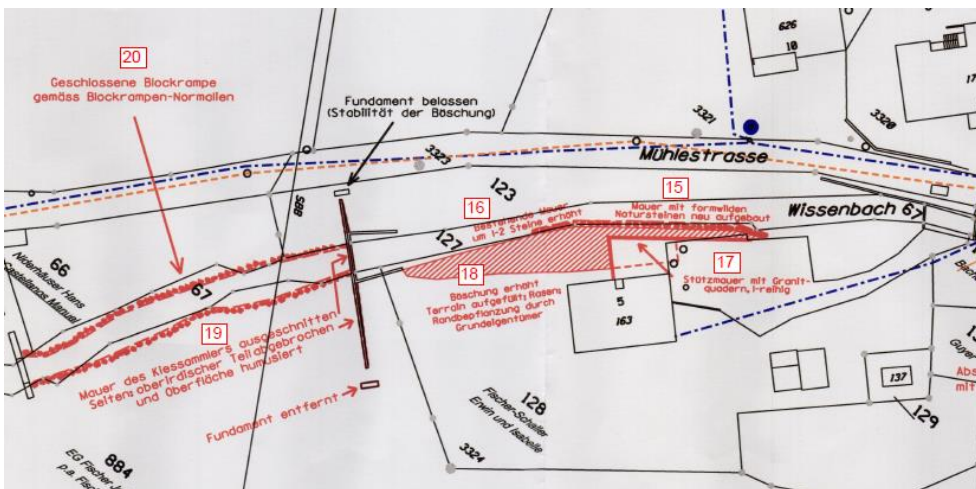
Ausgeführte Massnahmen gemäss Plan des ausgeführten Bauwerks [3], oberer Projektabschnitt
